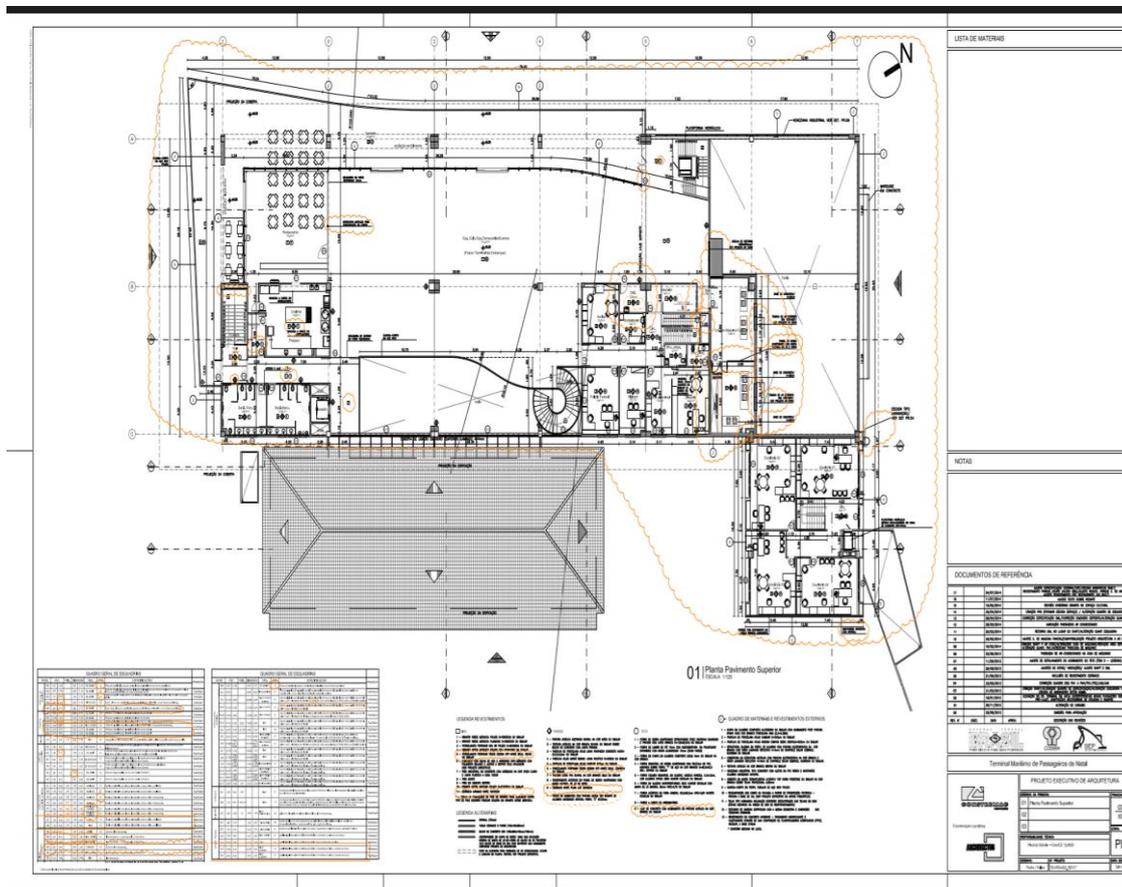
Planta 1º piso do Terminal Marítimo de Passageiros
